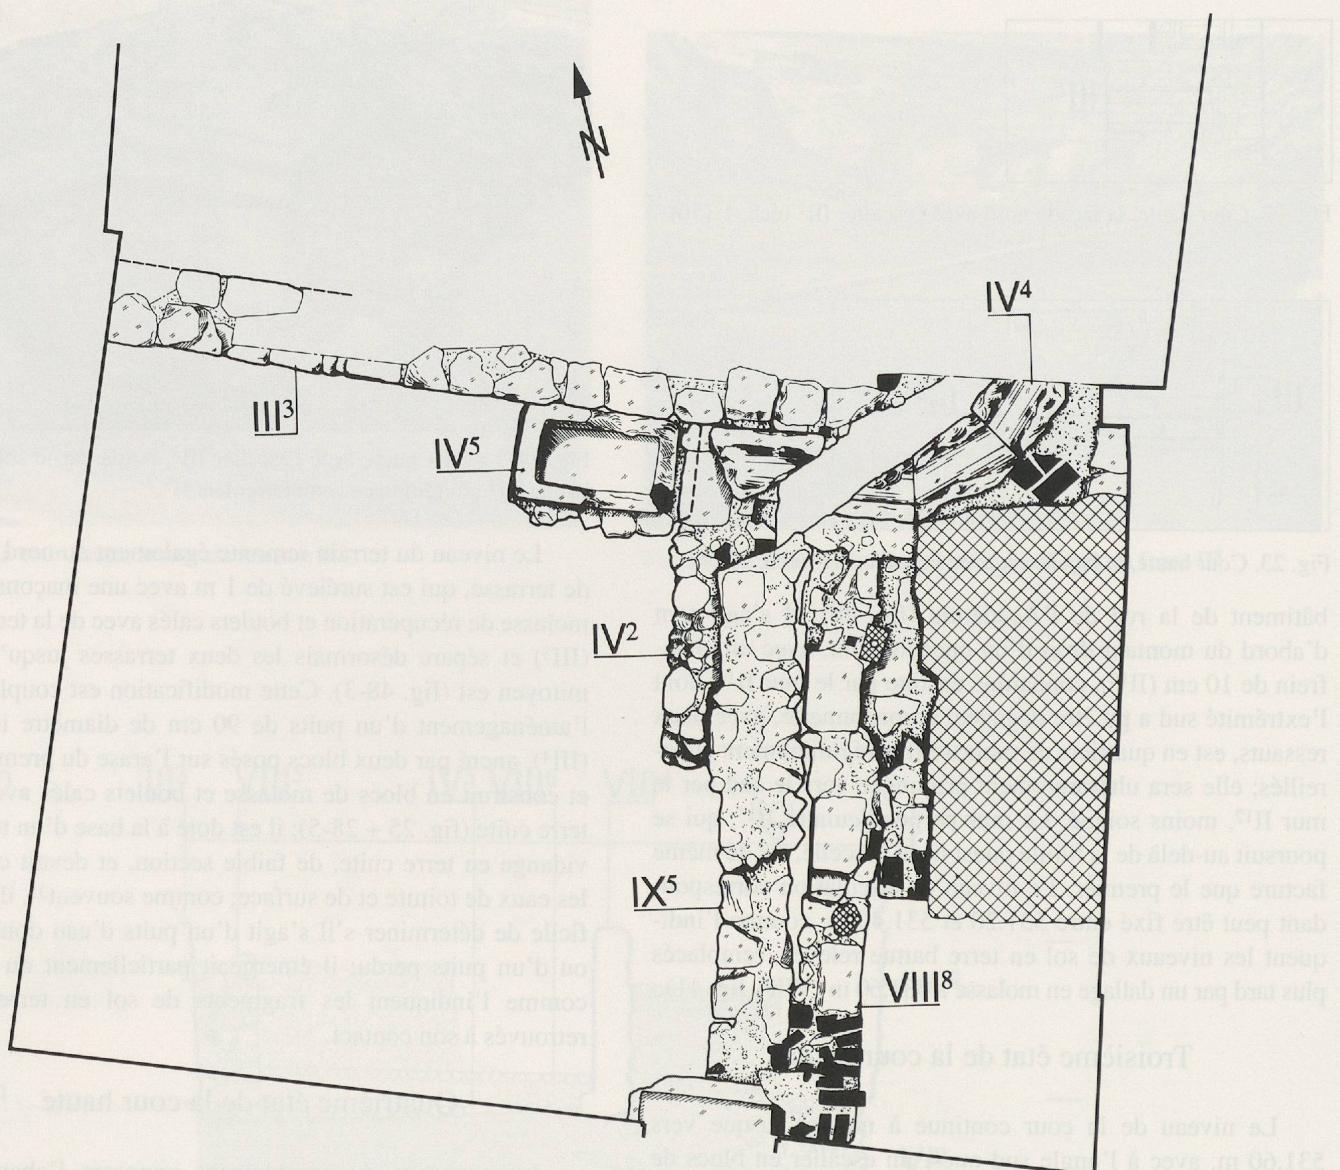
Cour haute: plan du premier décapage (éch. 1:50).
